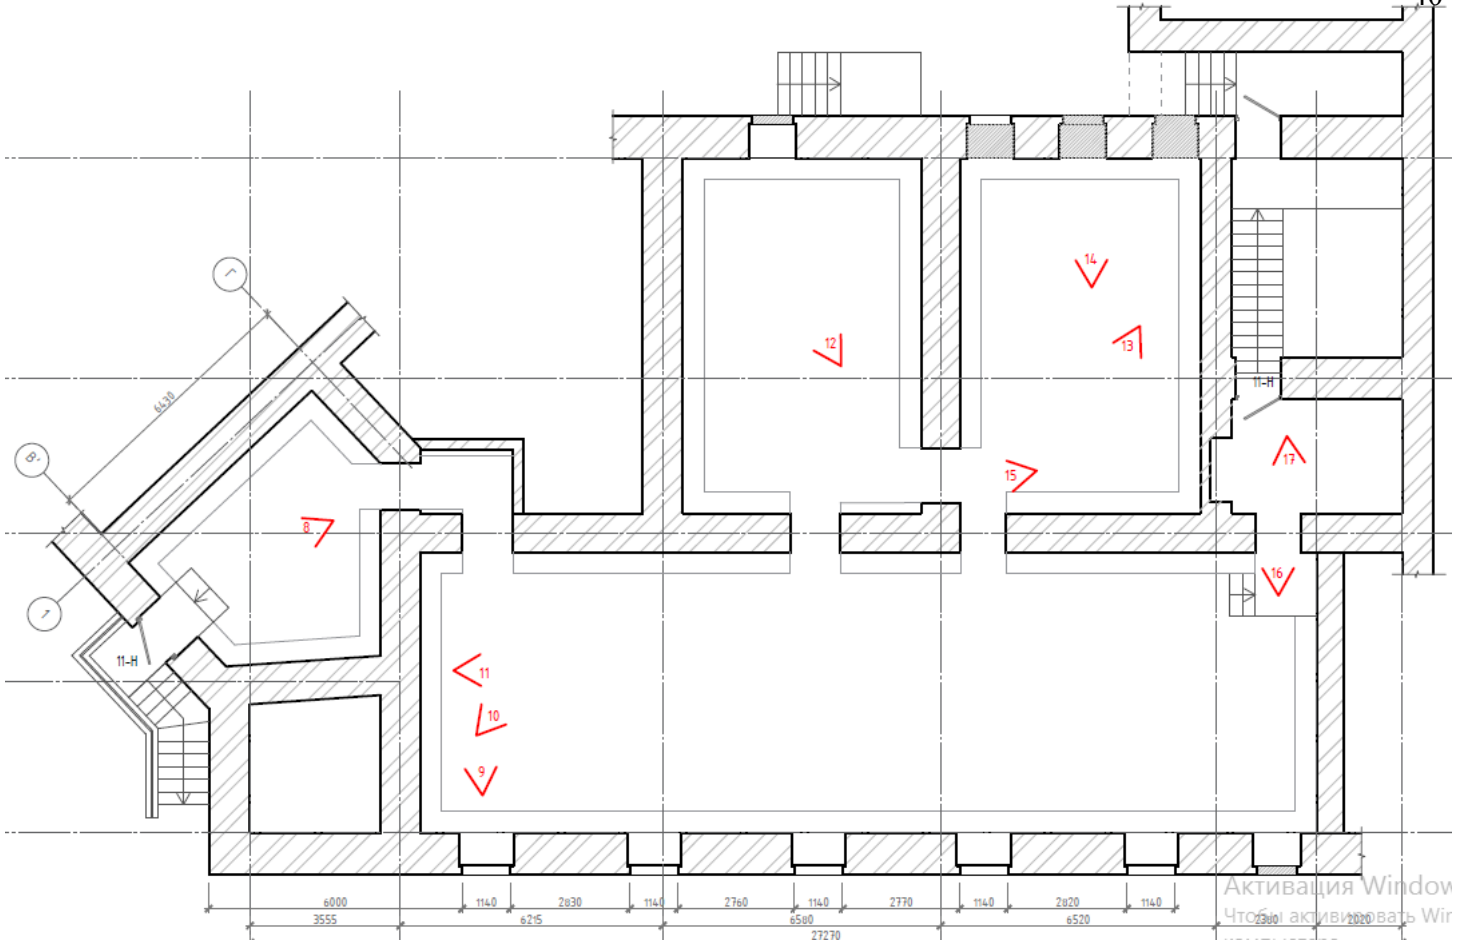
Схема фотофиксации на фрагменте плана подвального этажа
